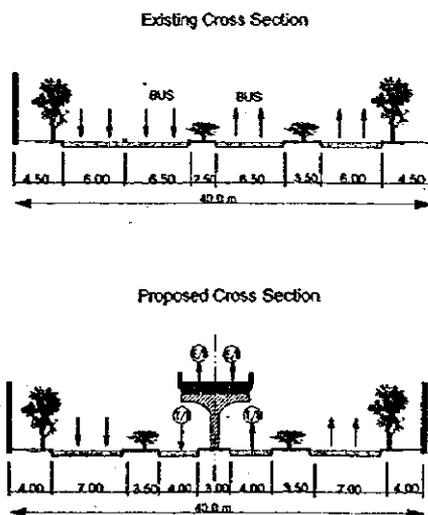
Sección Típica sobre Avenida Caracas
